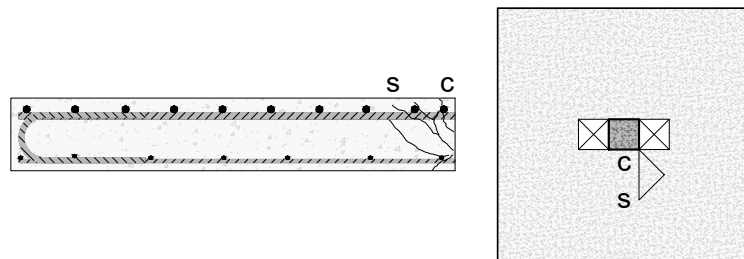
Padrão de fissuração da laje LFE3 - corte
